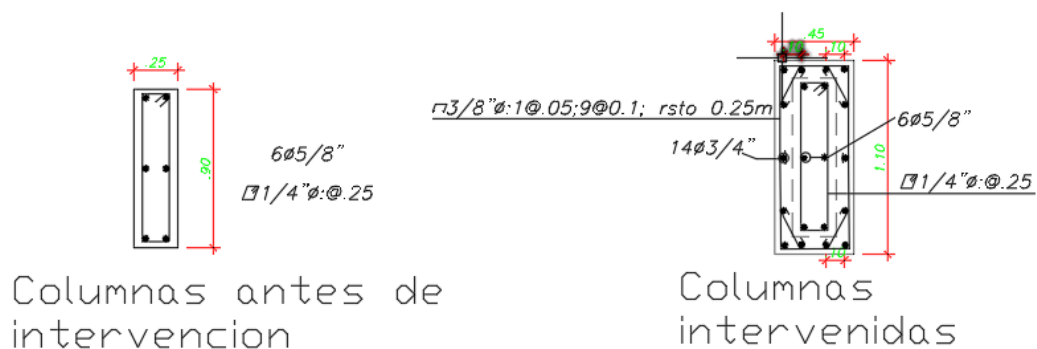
Propuesta de reforzamiento de las columnas críticas.
